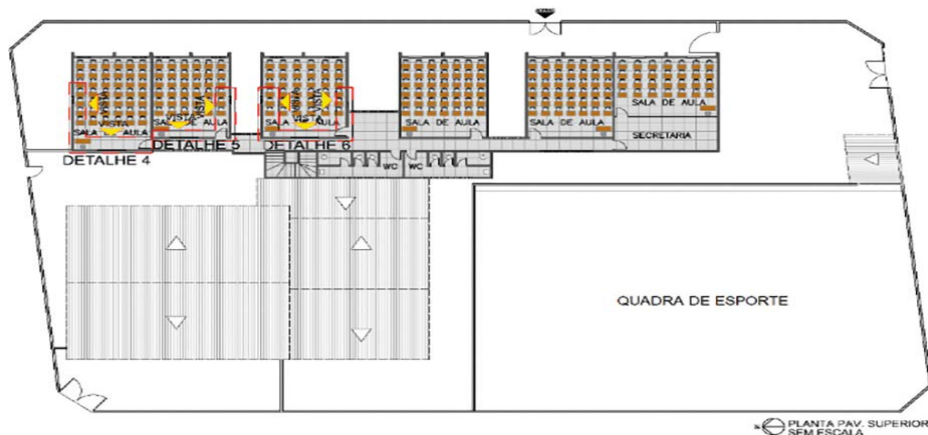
Planta Baixa das intervenções arquitetônicas na escola B.
